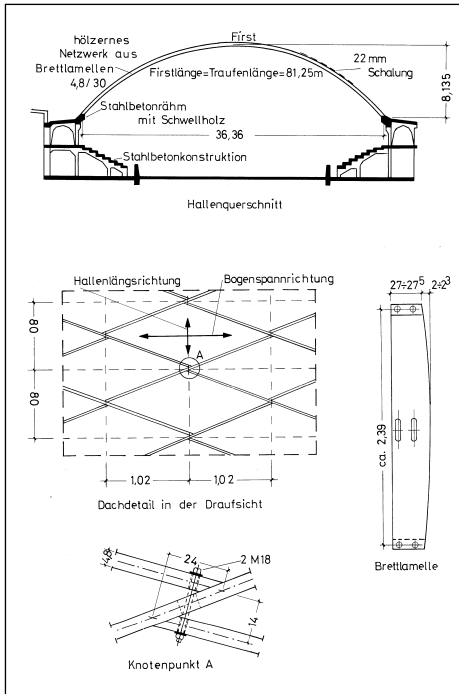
Halle Münsterland – Übersicht und Hauptabmessungen
